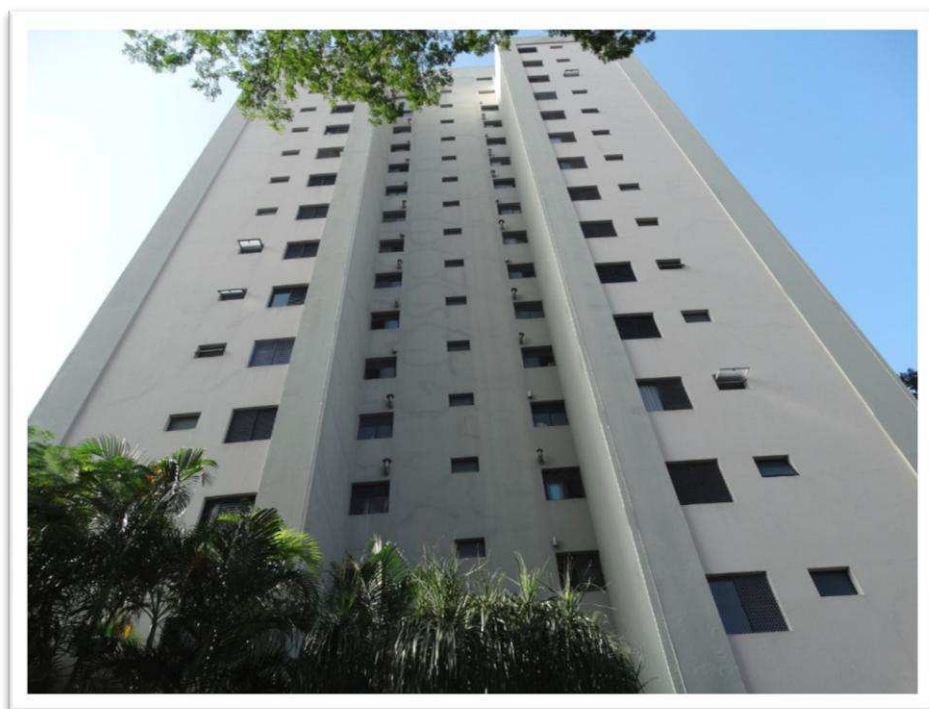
Vista da fachada lateral esquerda do Bloco “B”.
